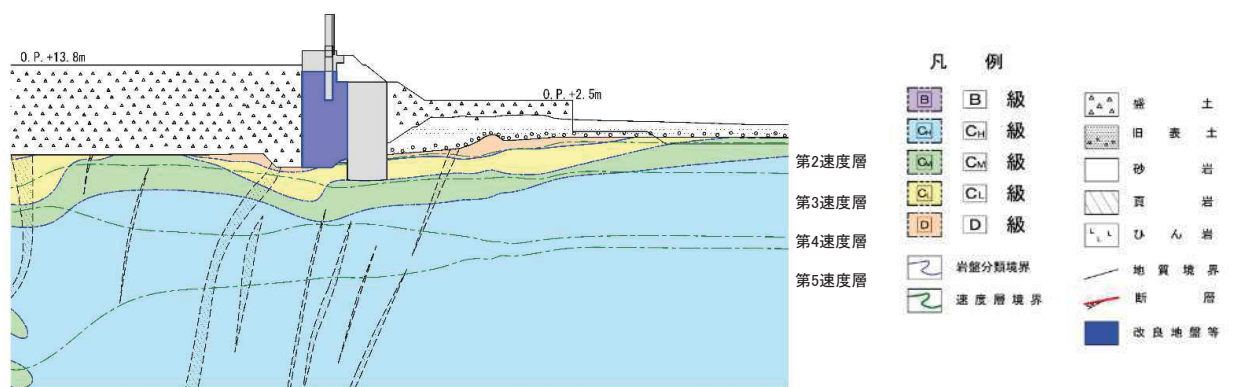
地盤改良体の配置図 (防潮堤 (鋼管式鉛直壁) 一般部, F-F 断面)
